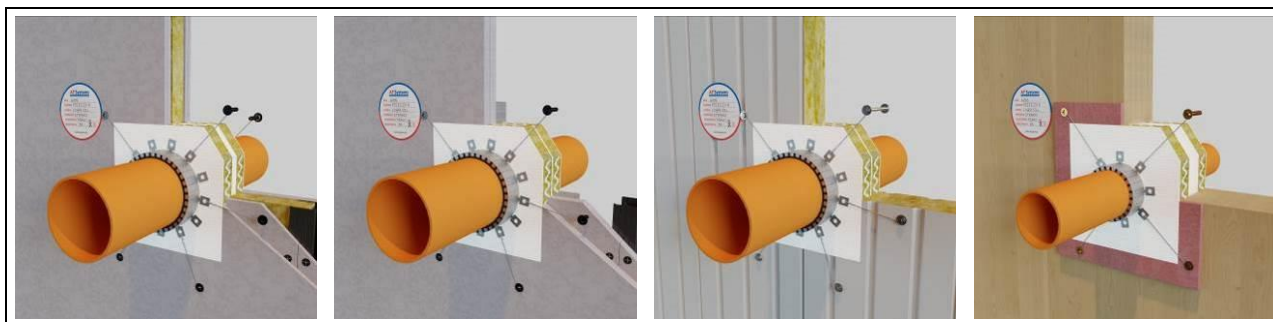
Exemple de joint de tuyaux en plastique (avec AF MULTICOLLAR) dans les murs.
